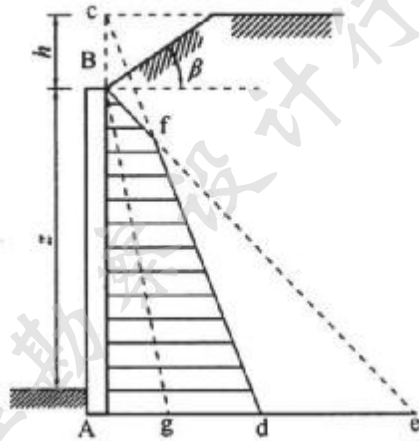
地面局部为斜面时支护结构上主动土压力的近似计算
